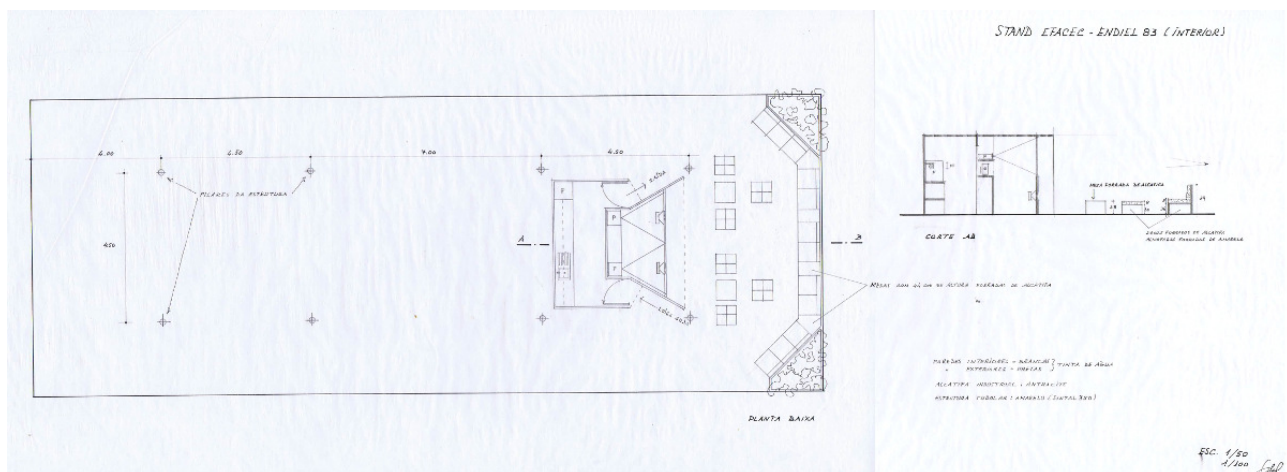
| Projecto do Stand da Efaced para a Endiel 83. Pavilhão interior. Planta baixa. 1981
